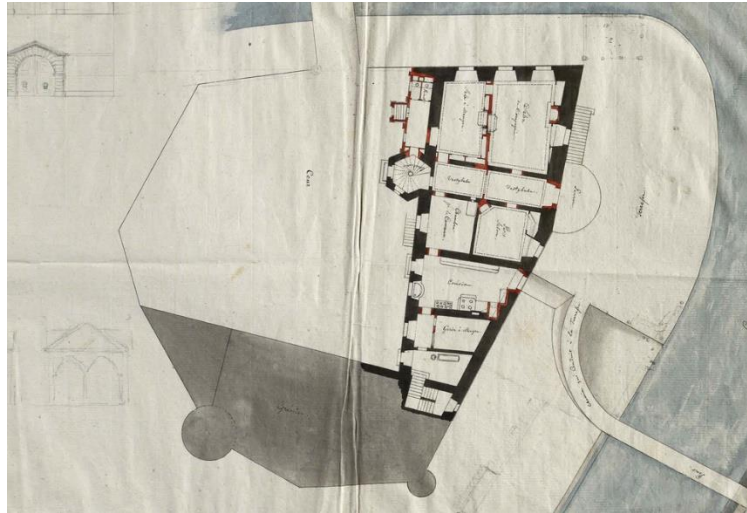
Schloss Landshut. Grundriss Erdgeschoss. Umbauplan um 1812<sup>13</sup>
